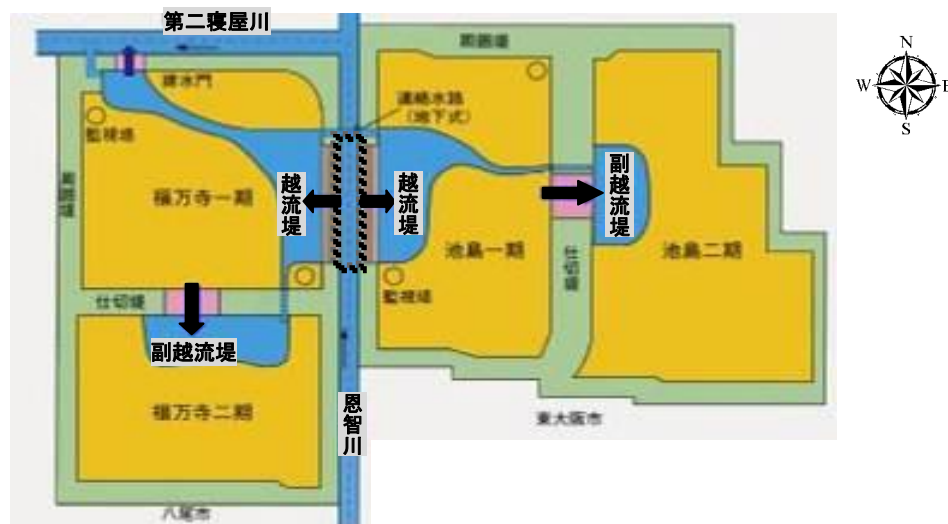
恩智川治水緑地(池島・福万寺) 平面図
